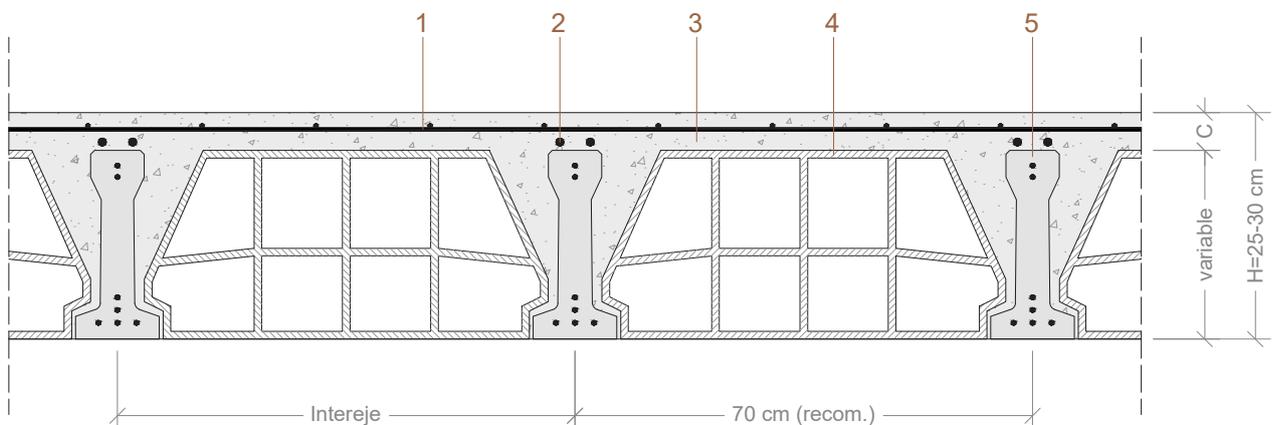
Sección tipo de forjado con viguetas autorresistentes
